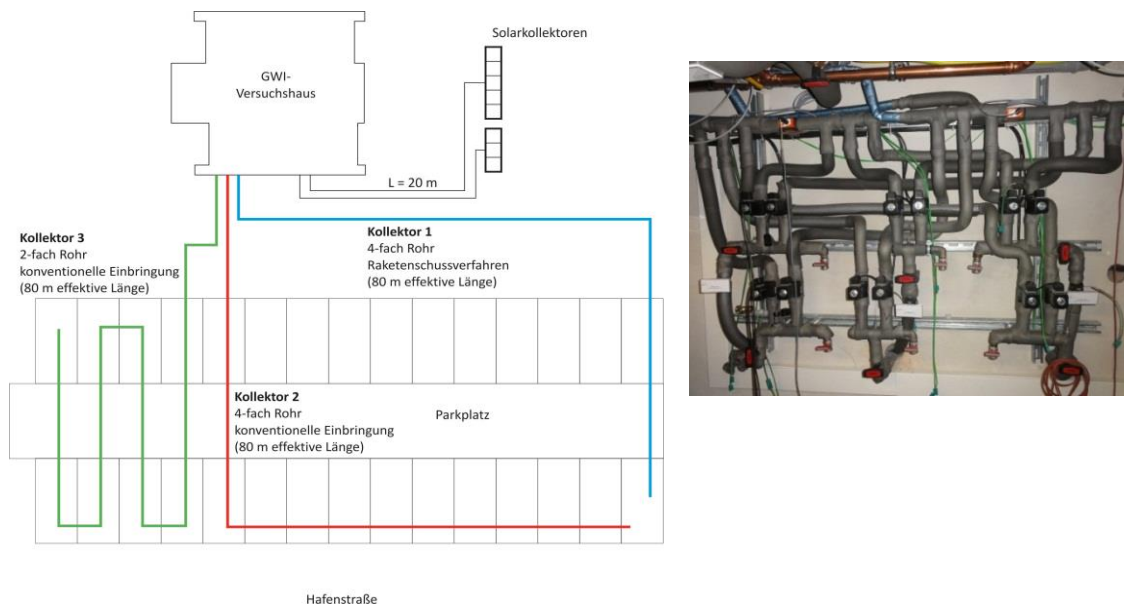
Vor dem Versuchshaus verlegte Flächenkollektoren und Hydraulik zur Umschaltung der Flächenkollektoren
